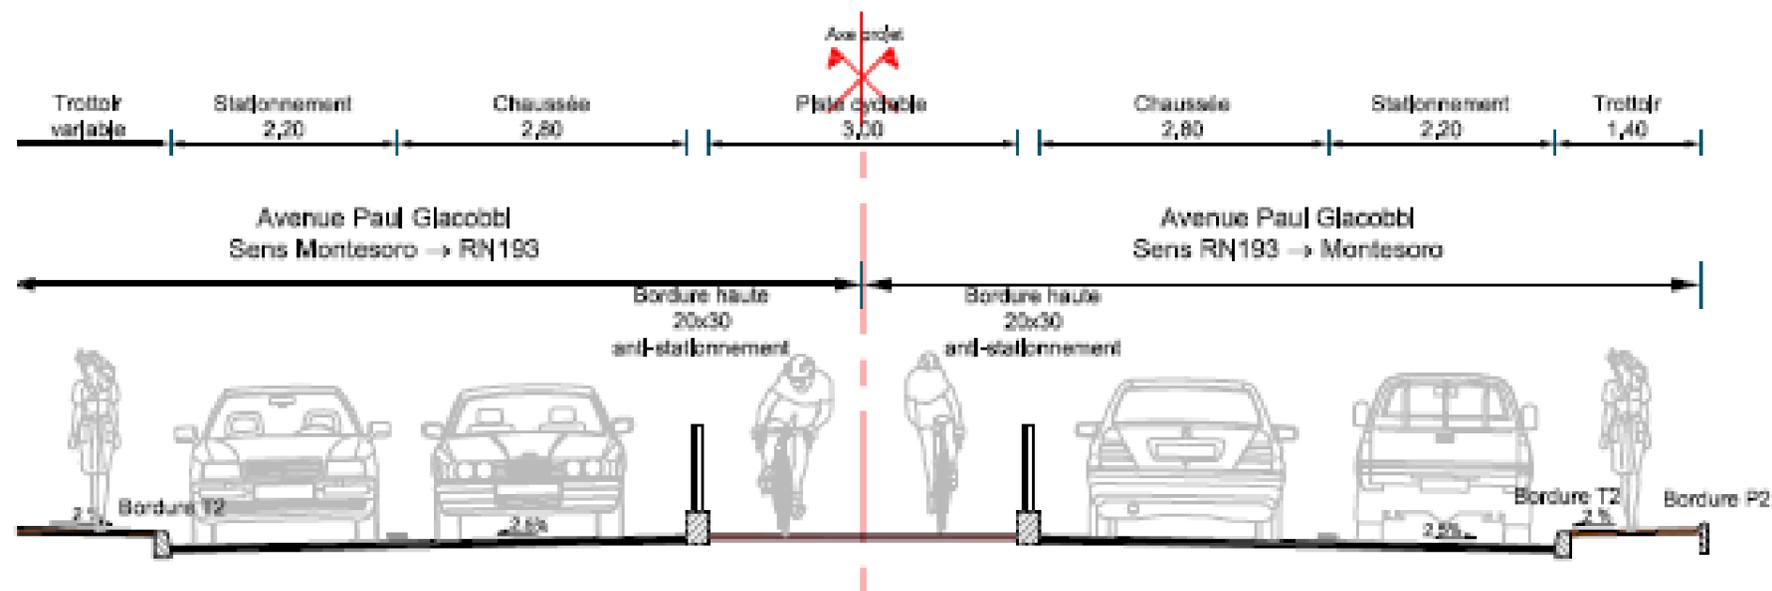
PROFIL EN TRAVERS TYPE AVENUE PAUL GIACOBBI
